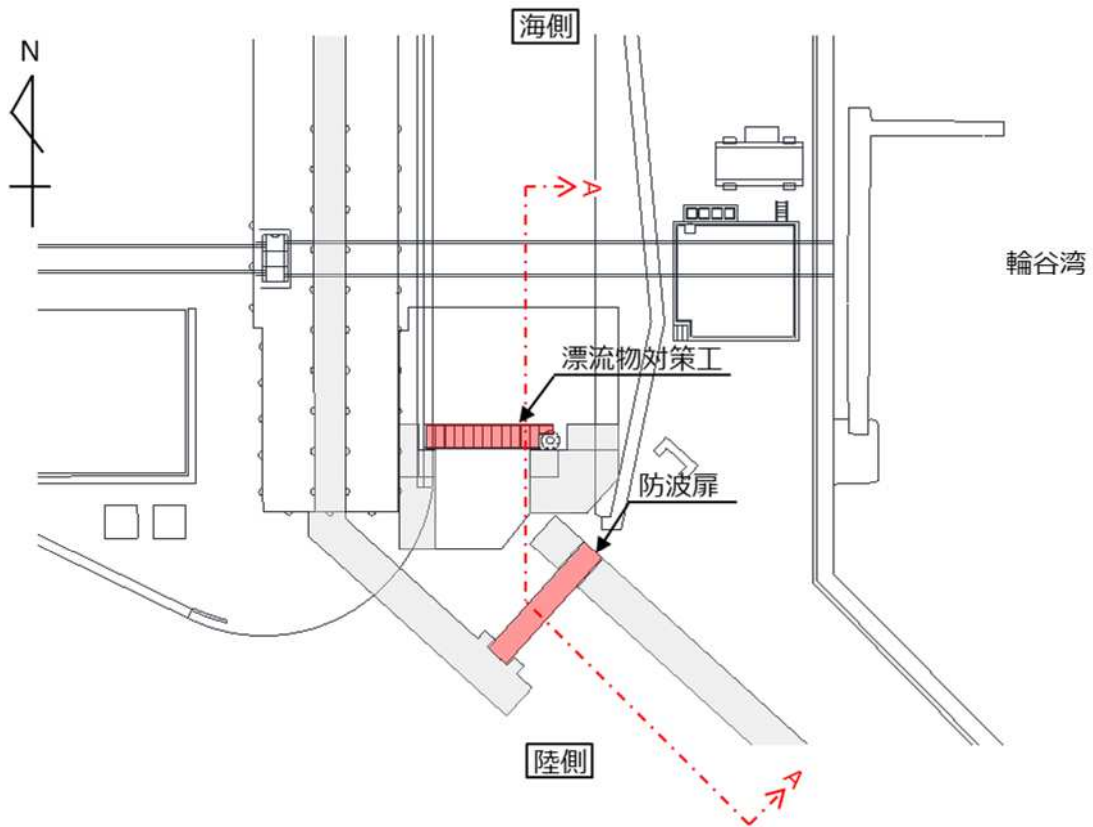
(1) 防波壁通路防波扉（荷揚場南） 平面図
